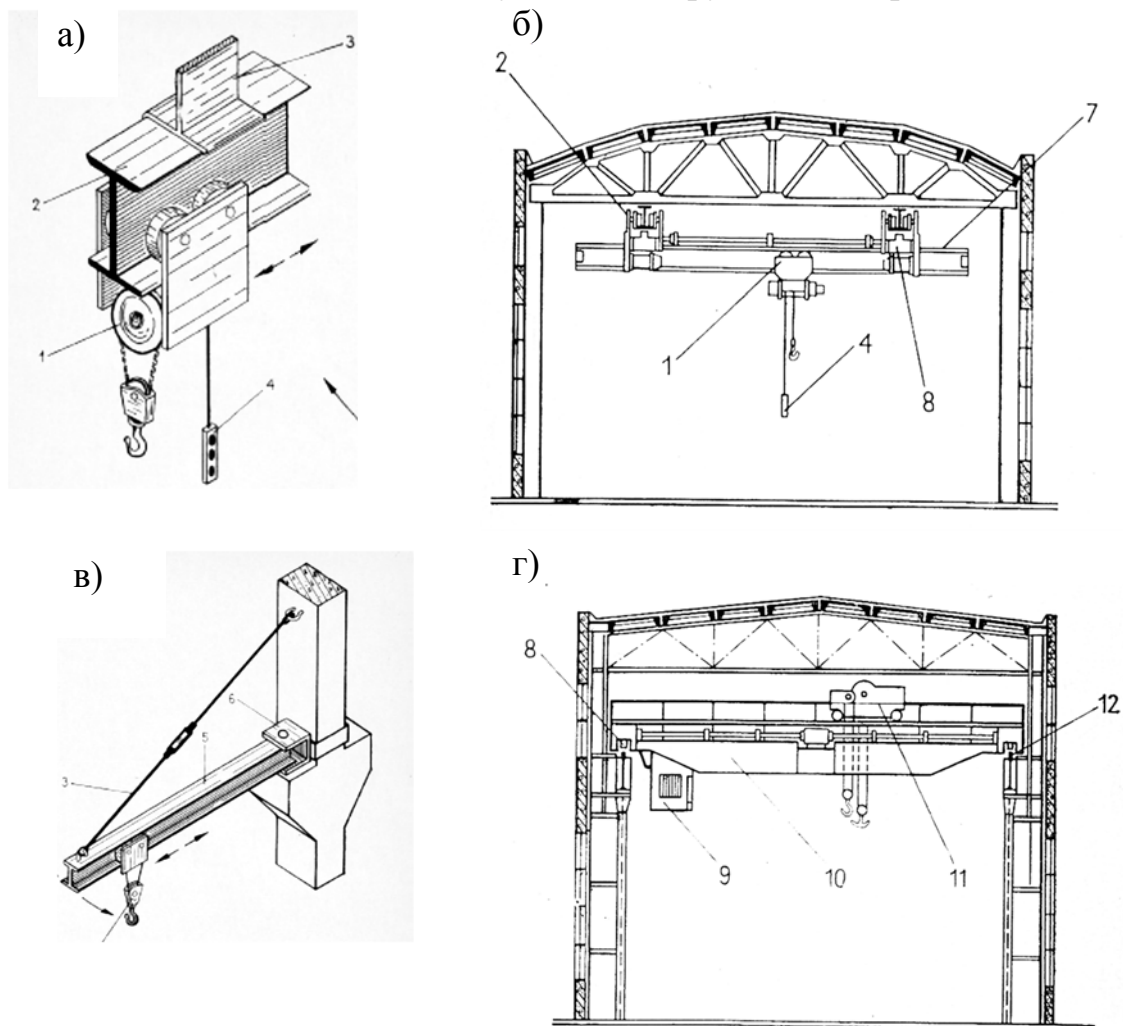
Подъемно-транспортное оборудование промышленных зданий:
